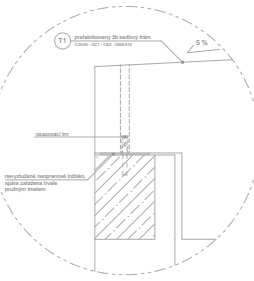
DETAIL NAPOJENÍ PREFA. SCHODŮ ELEVACE
